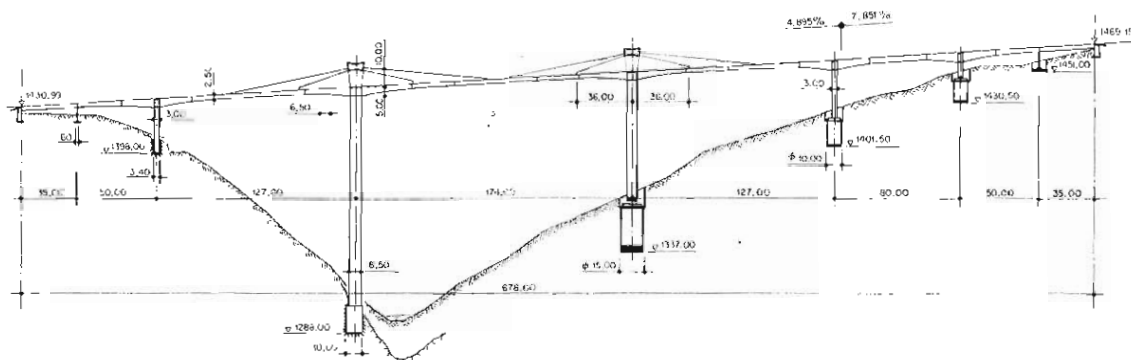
Alzado del proyecto del puente Ganter en la carretera del Simplón.
